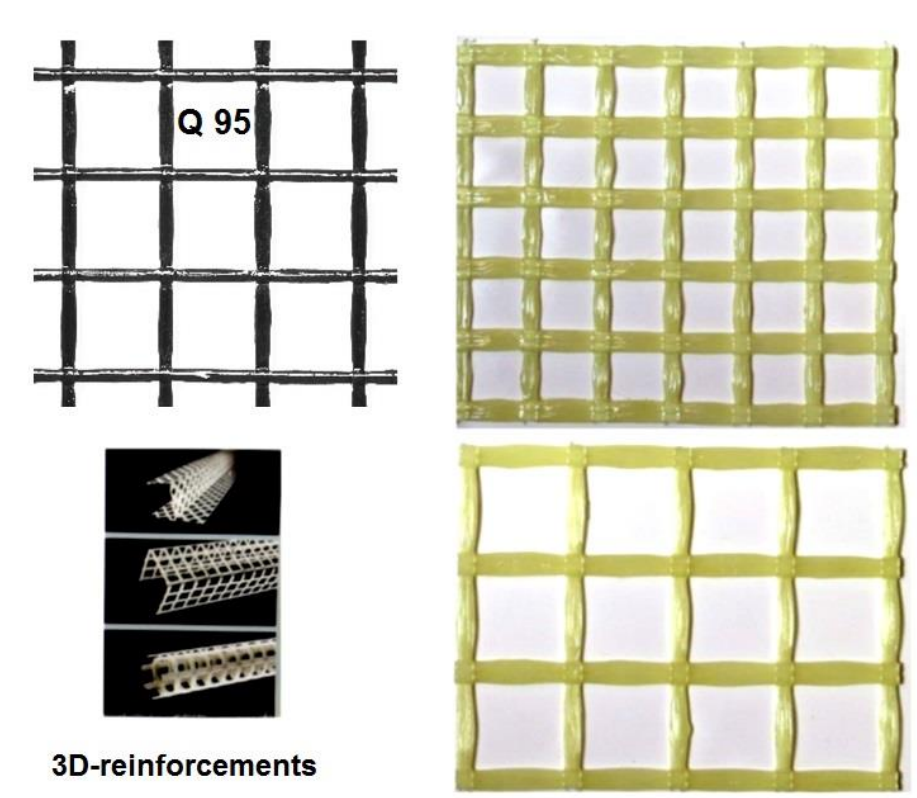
2D-Bewehrungsstrukturen ('Bewehrungsgitter') und räumliche Bewehrungskörbe.
